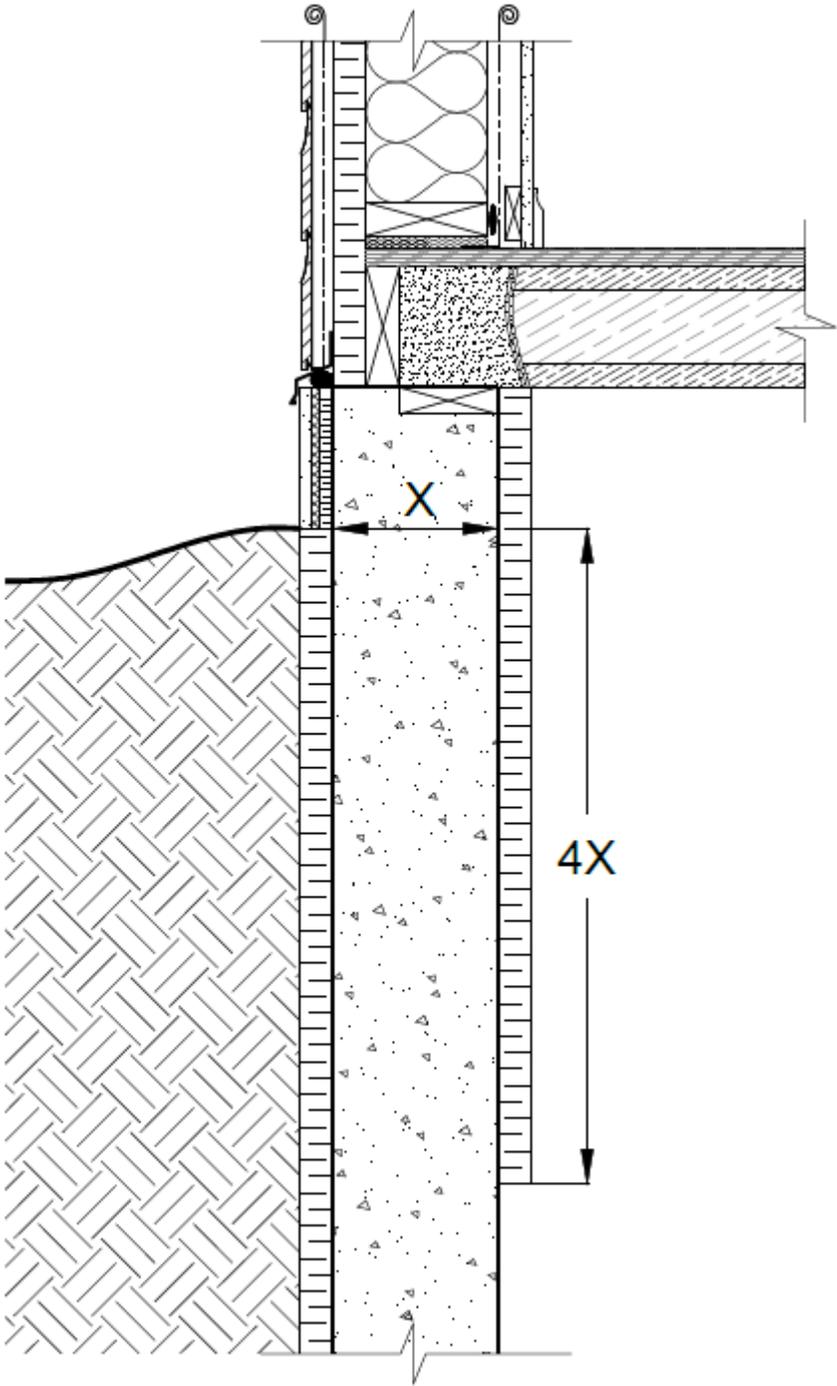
Exemption pour le chevauchement des plans d'isolation (art.2.1.3.8a)i)
